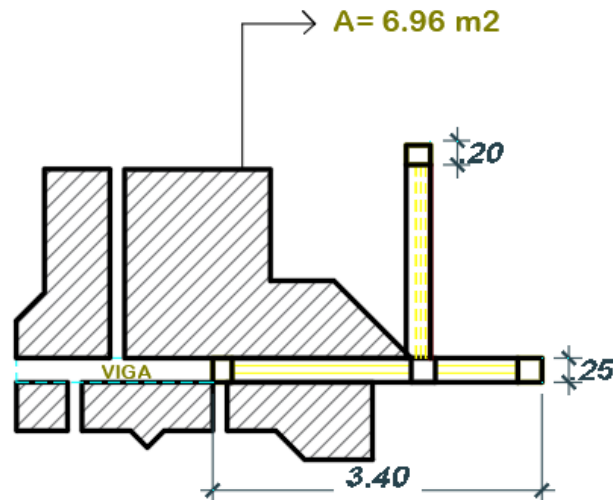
Área tributaria del muro X3 en primer y segundo entrepiso
